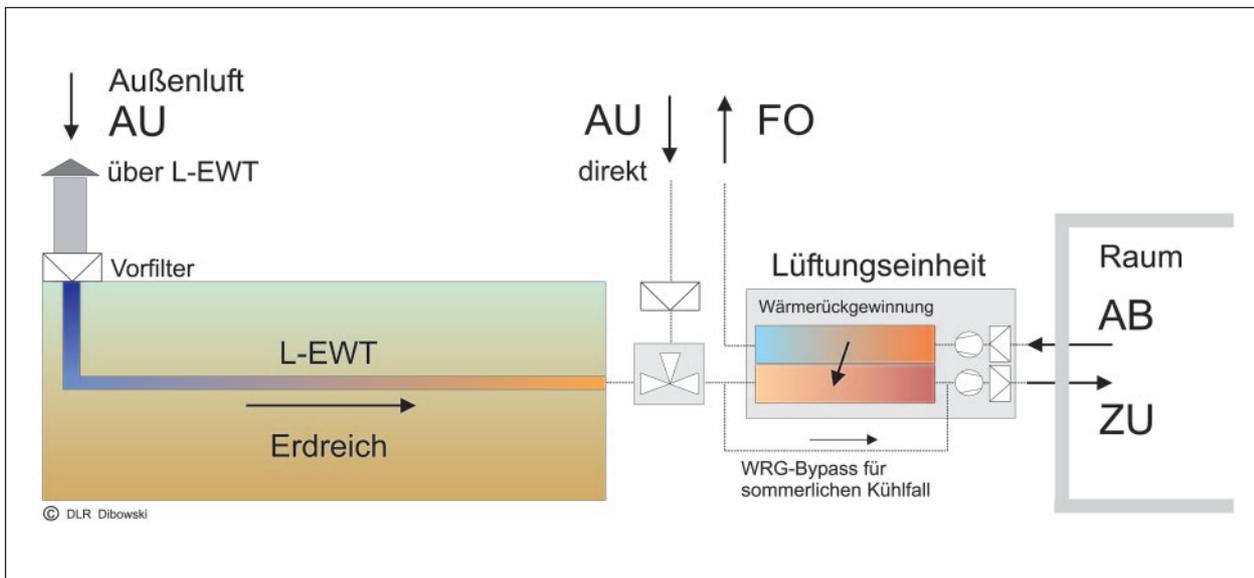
Prinzip der Luftführung einer Lüftungsanlage mit L-EWT
